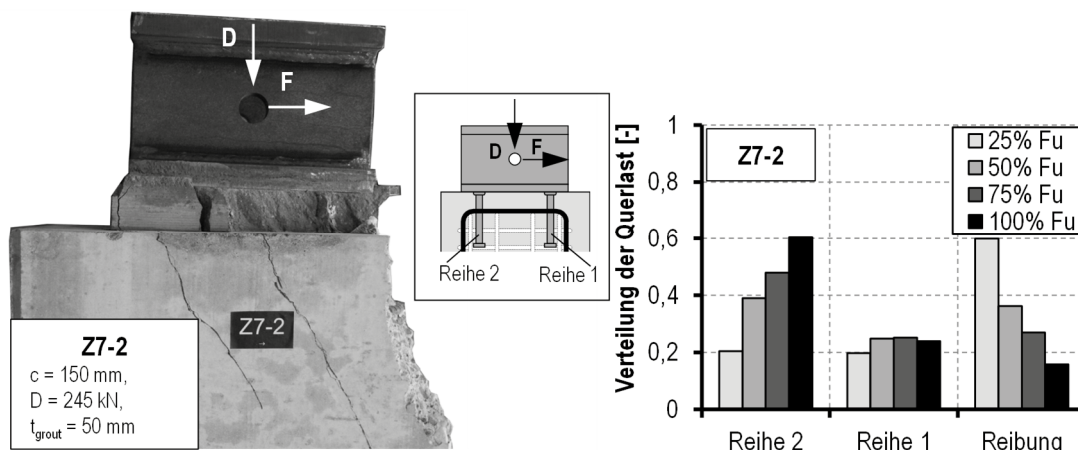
Versuchskörper Z7-2 mit Betonkantenbruch nach Versuchsende (links) und zugehörig numersich ermittelte Querlastverteilung im Anschluss für verschiedene Laststufen (rechts)
